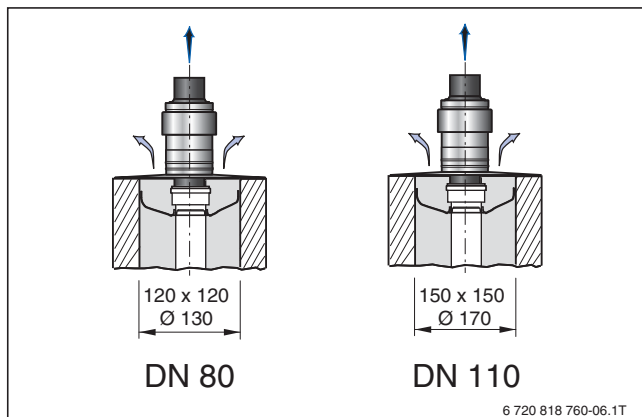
Mindestmaße des Schachtquerschnitts für die Montage der Abgasleitung des Bausatzes GA (Maße in mm)
